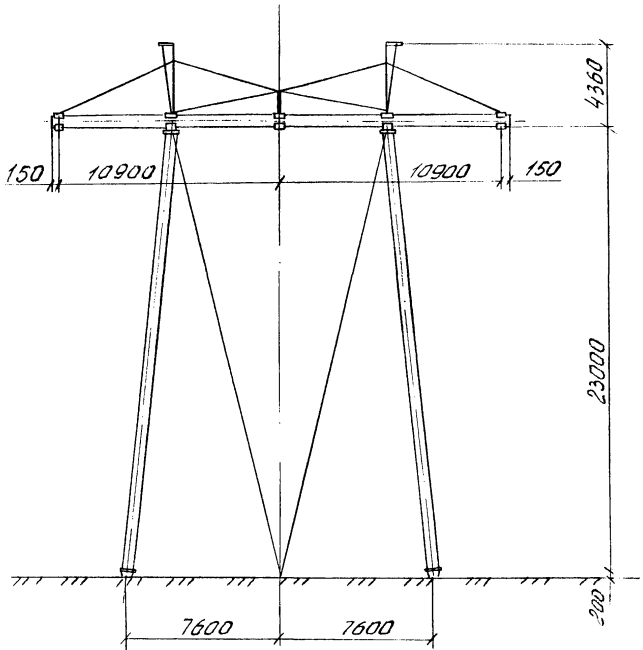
Промежуточная железобетонная опора типа ПБ 500-1
